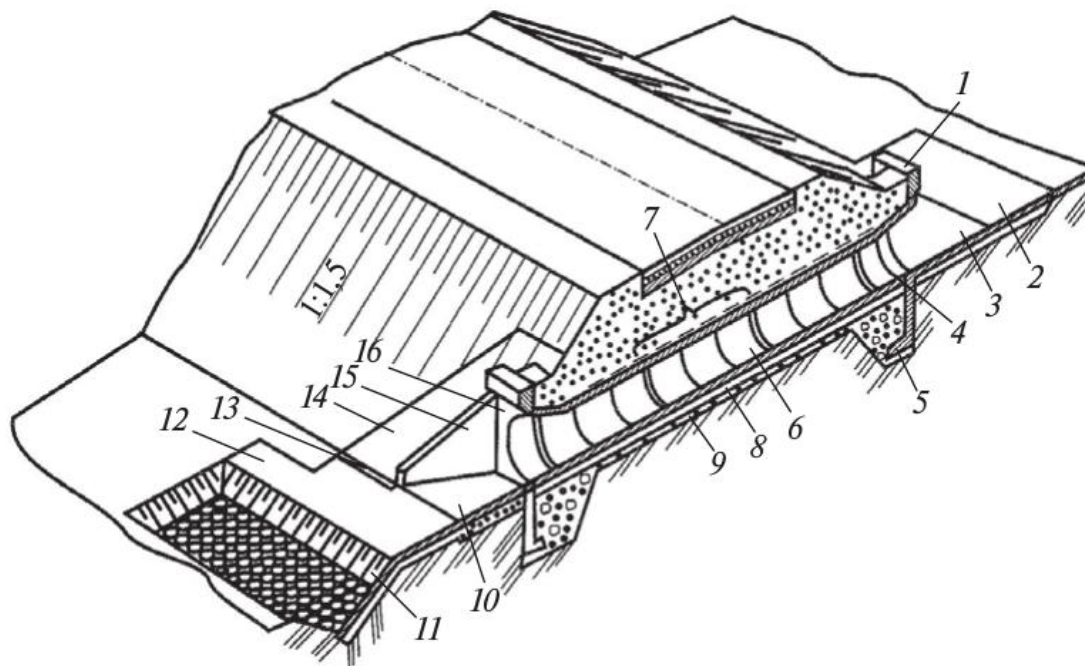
Элементы круглой железобетонной трубы (гидроизоляция не показана): 1 – портал входного оголовка; 2 – укрепление подводящего русла; 3 – укрепление лотка входного оголовка; 4 – коническое звено; 5 – фундамент порталной стенки входного оголовка; 6 – цилиндрическое звено; 7 – секция звеньев; 8 – фундаментный блок; 9 – щебеночная подготовка; 10 – укрепление лотка выходного оголовка; 11 – воронка размыва с каменной наброской; 12 – укрепление отводящего русла; 13 – бетонный упор; 14 – укрепление откоса насыпи; 15 – откосное крыло; 16 – порталная стенка выходного оголовка
